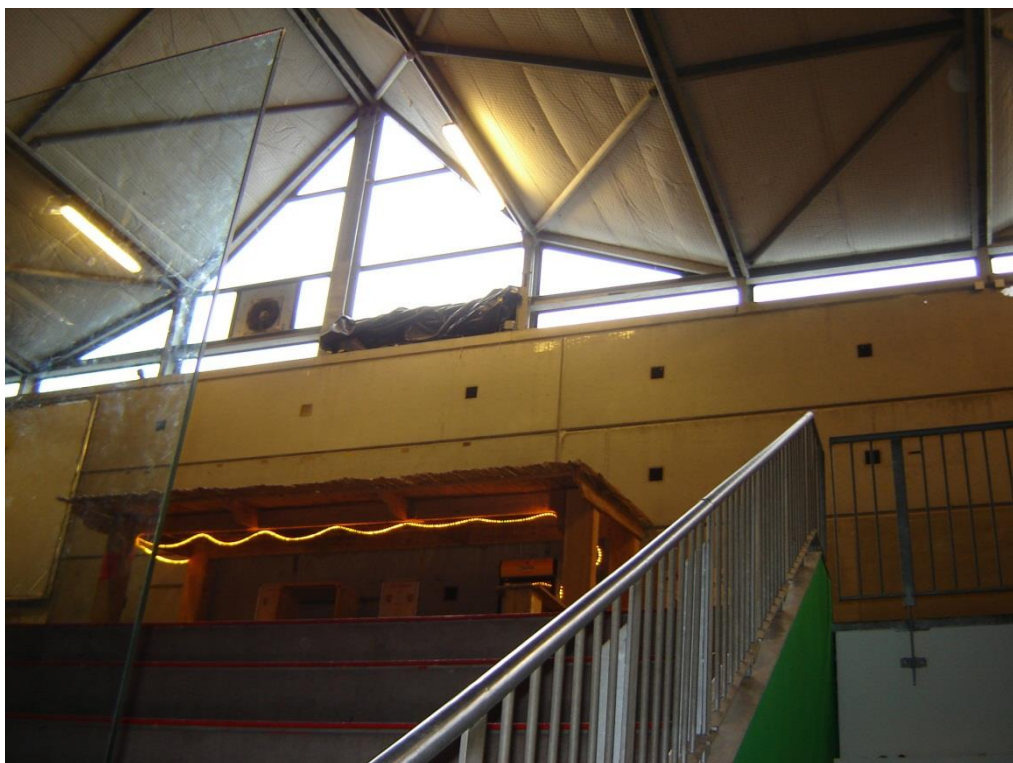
Glaspanelen bovenin de ijshockeybaan en prefab betonwand.
